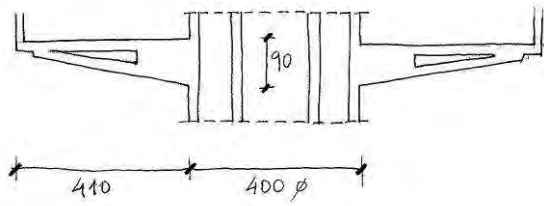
Sección de la estructura inferior del Rogers Hotel Lacy, donde los diferentes niveles se proyectan en voladizo tanto hacia la fachada exterior como hacia el interior del atrio desde unos núcleos centrales.
